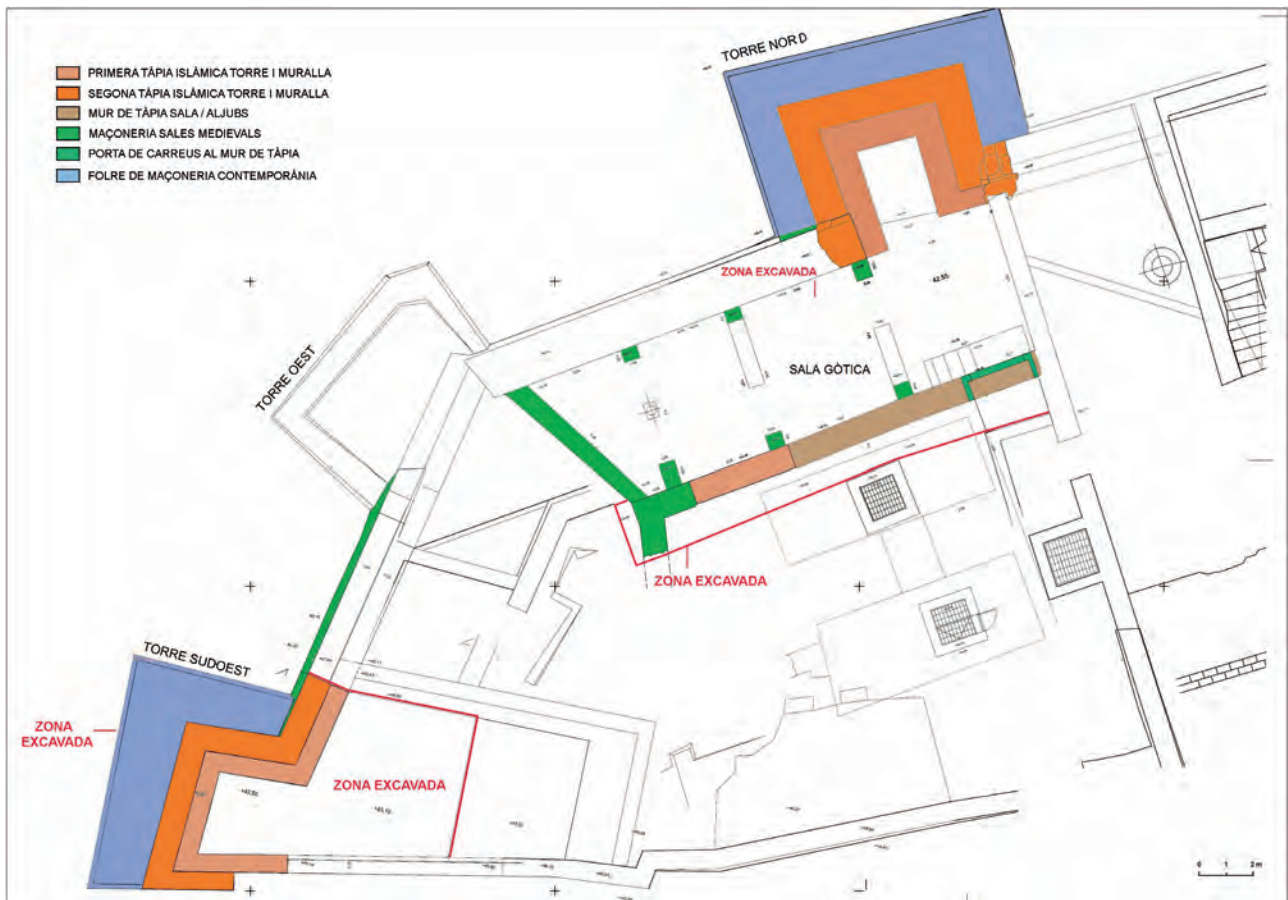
Planta general de l'excavació en les dues torres i la sala.
